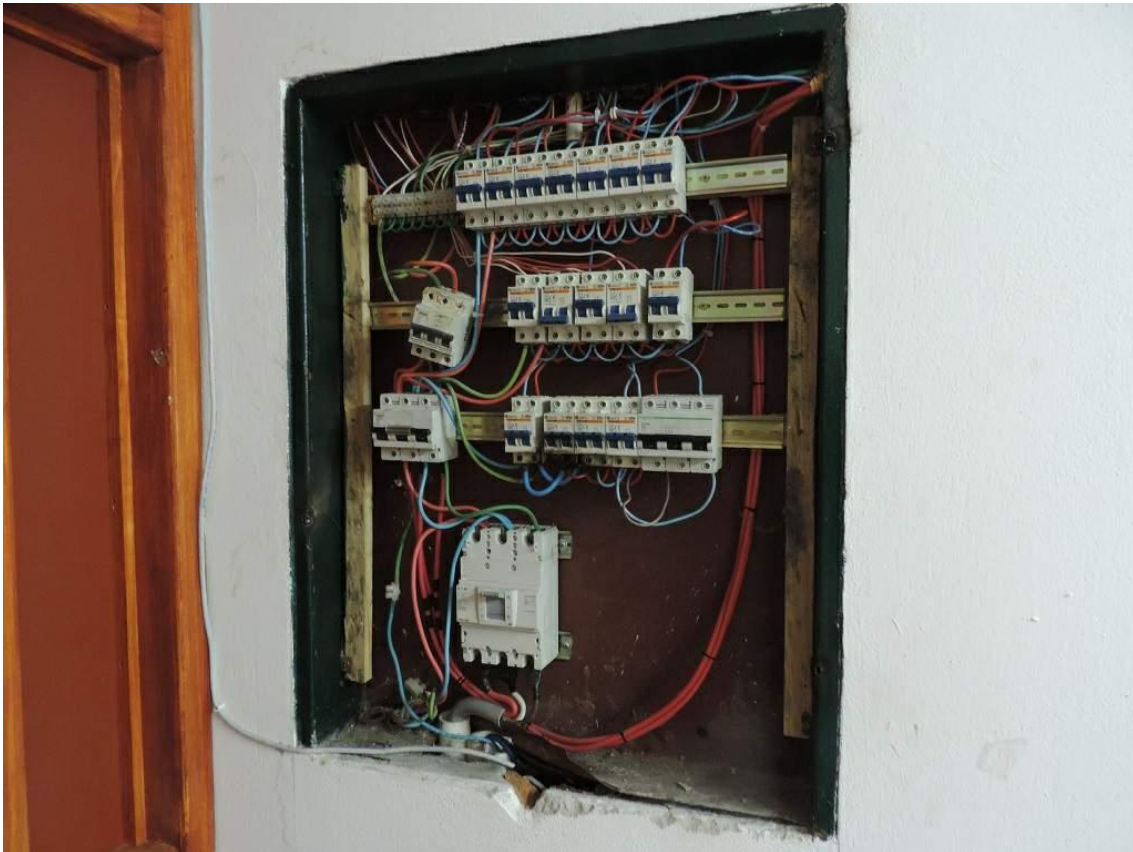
Tablero de distribución en corredor de acceso a biblioteca niveles 4 y 5
